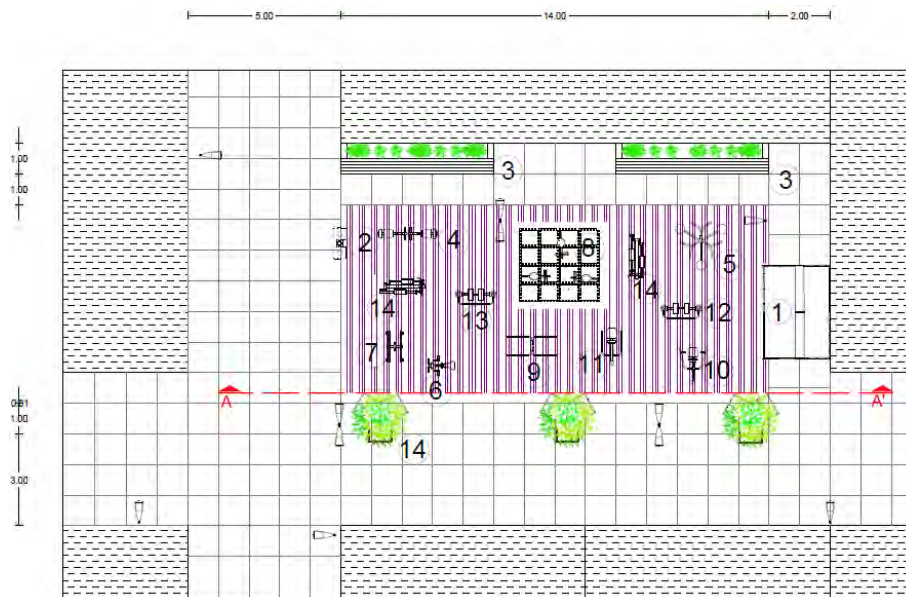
Planta arquitectónica de la plaza 6. Se observa la distribución del mobiliario ocupado y el cambio de piso.
